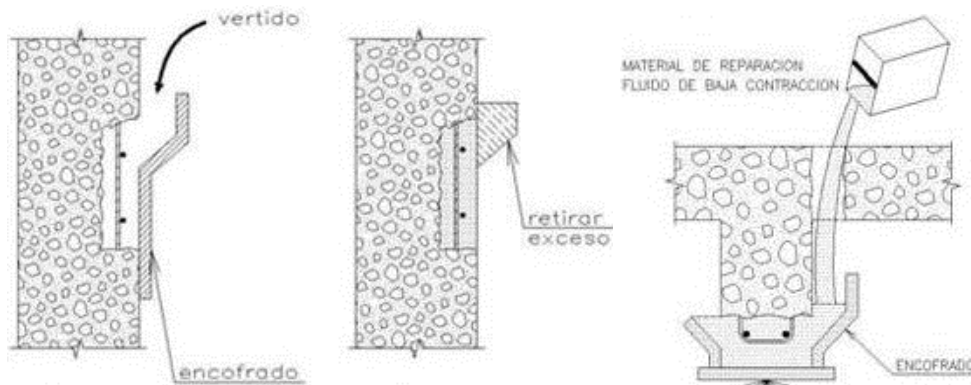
Colocación de material epóxico al concreto existente y al acero
